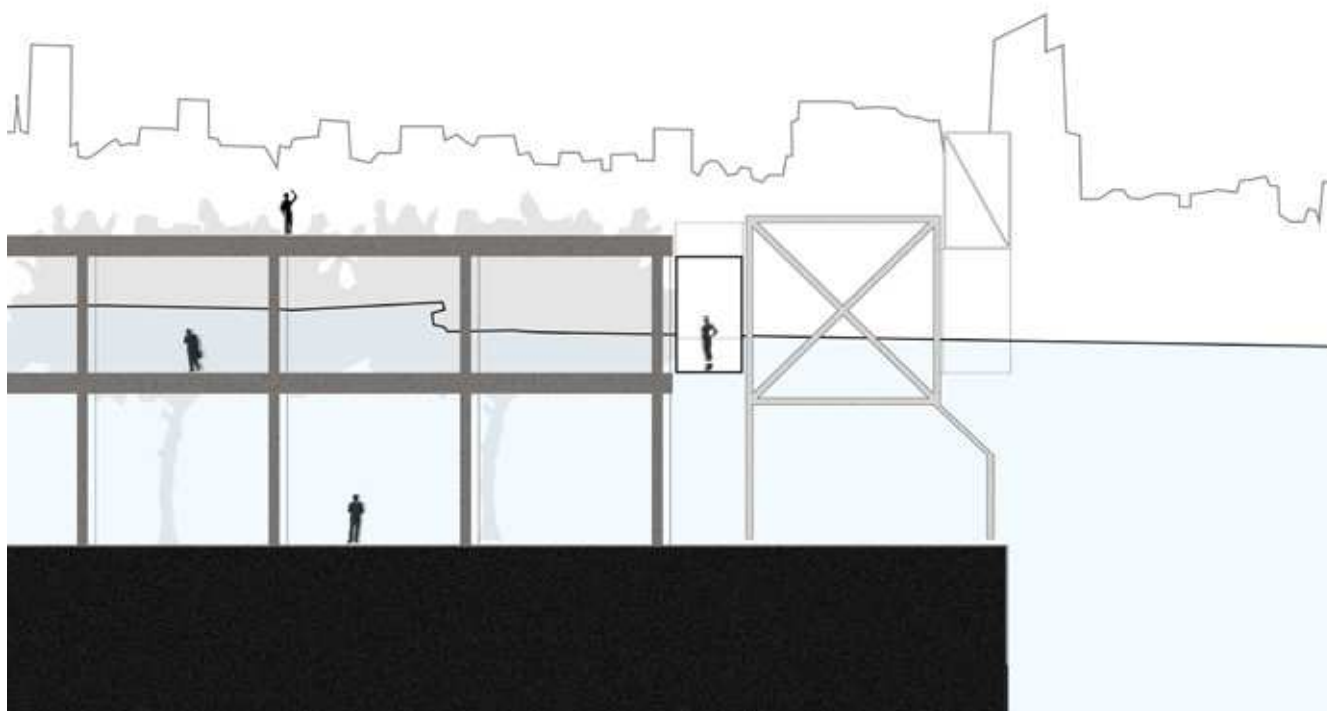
COLAGEM DA PROPOSTA ELABORADA PARA A ZONA TERMINAL DE PASSAGEIROS
